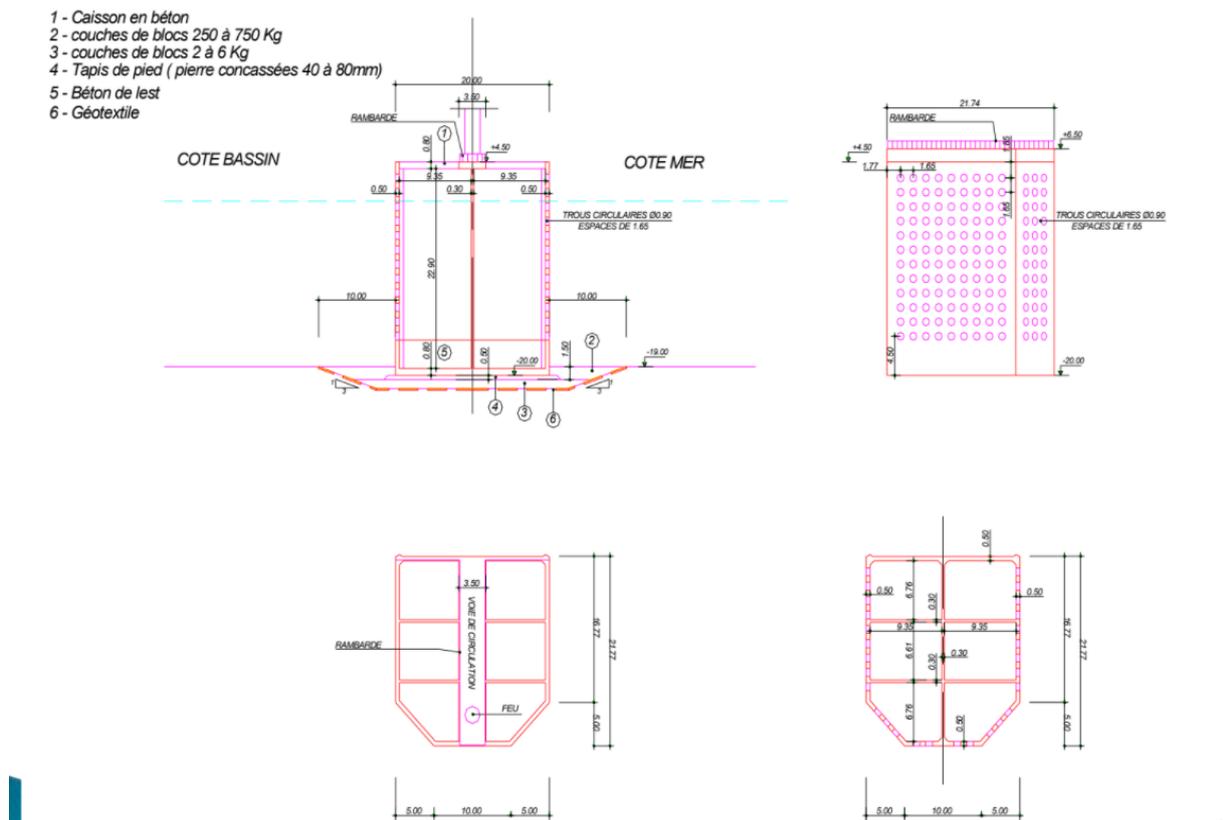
Les différentes coupes des plans du caisson pour la jetée Nord.
